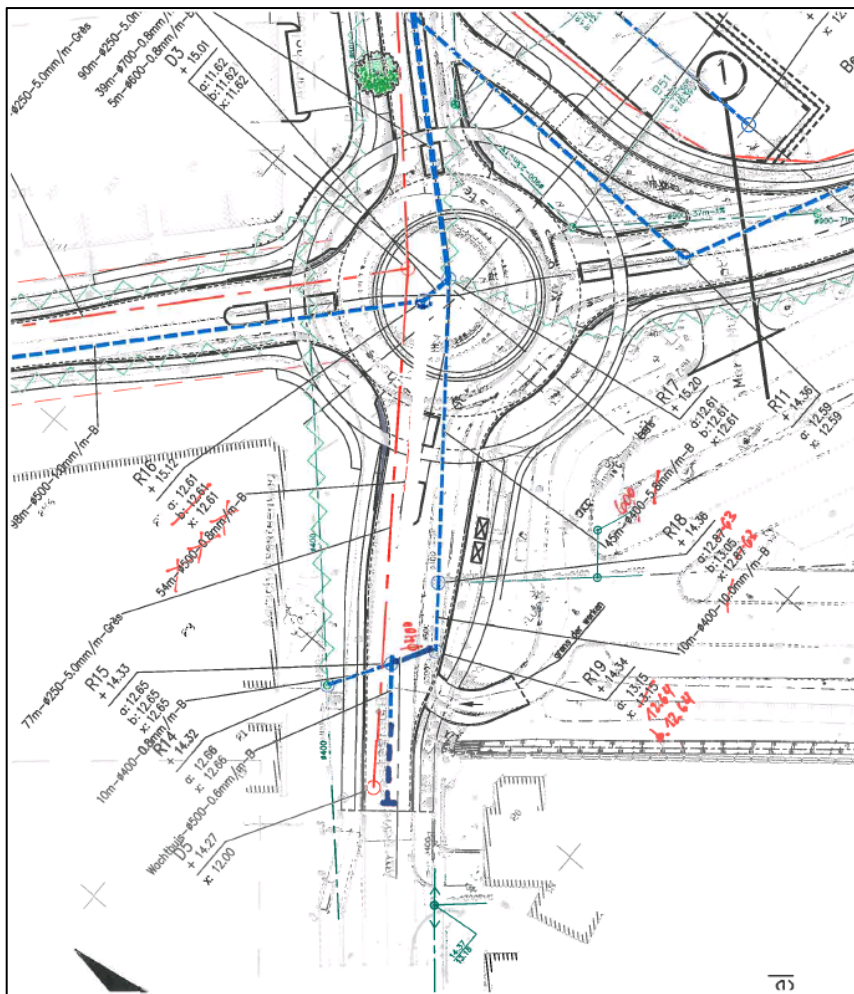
Rioleringsplan noordelijk gedeelte plangebied.
